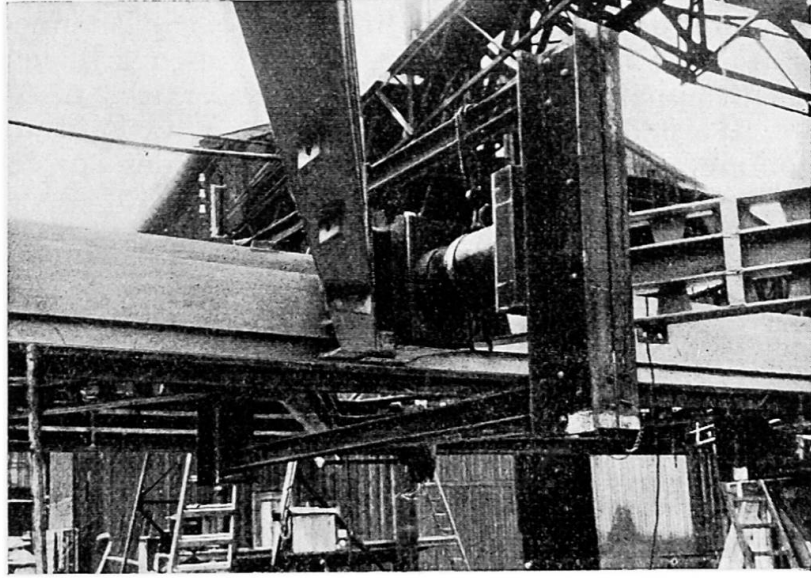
Assemblage d'une poutre à l'atelier.
